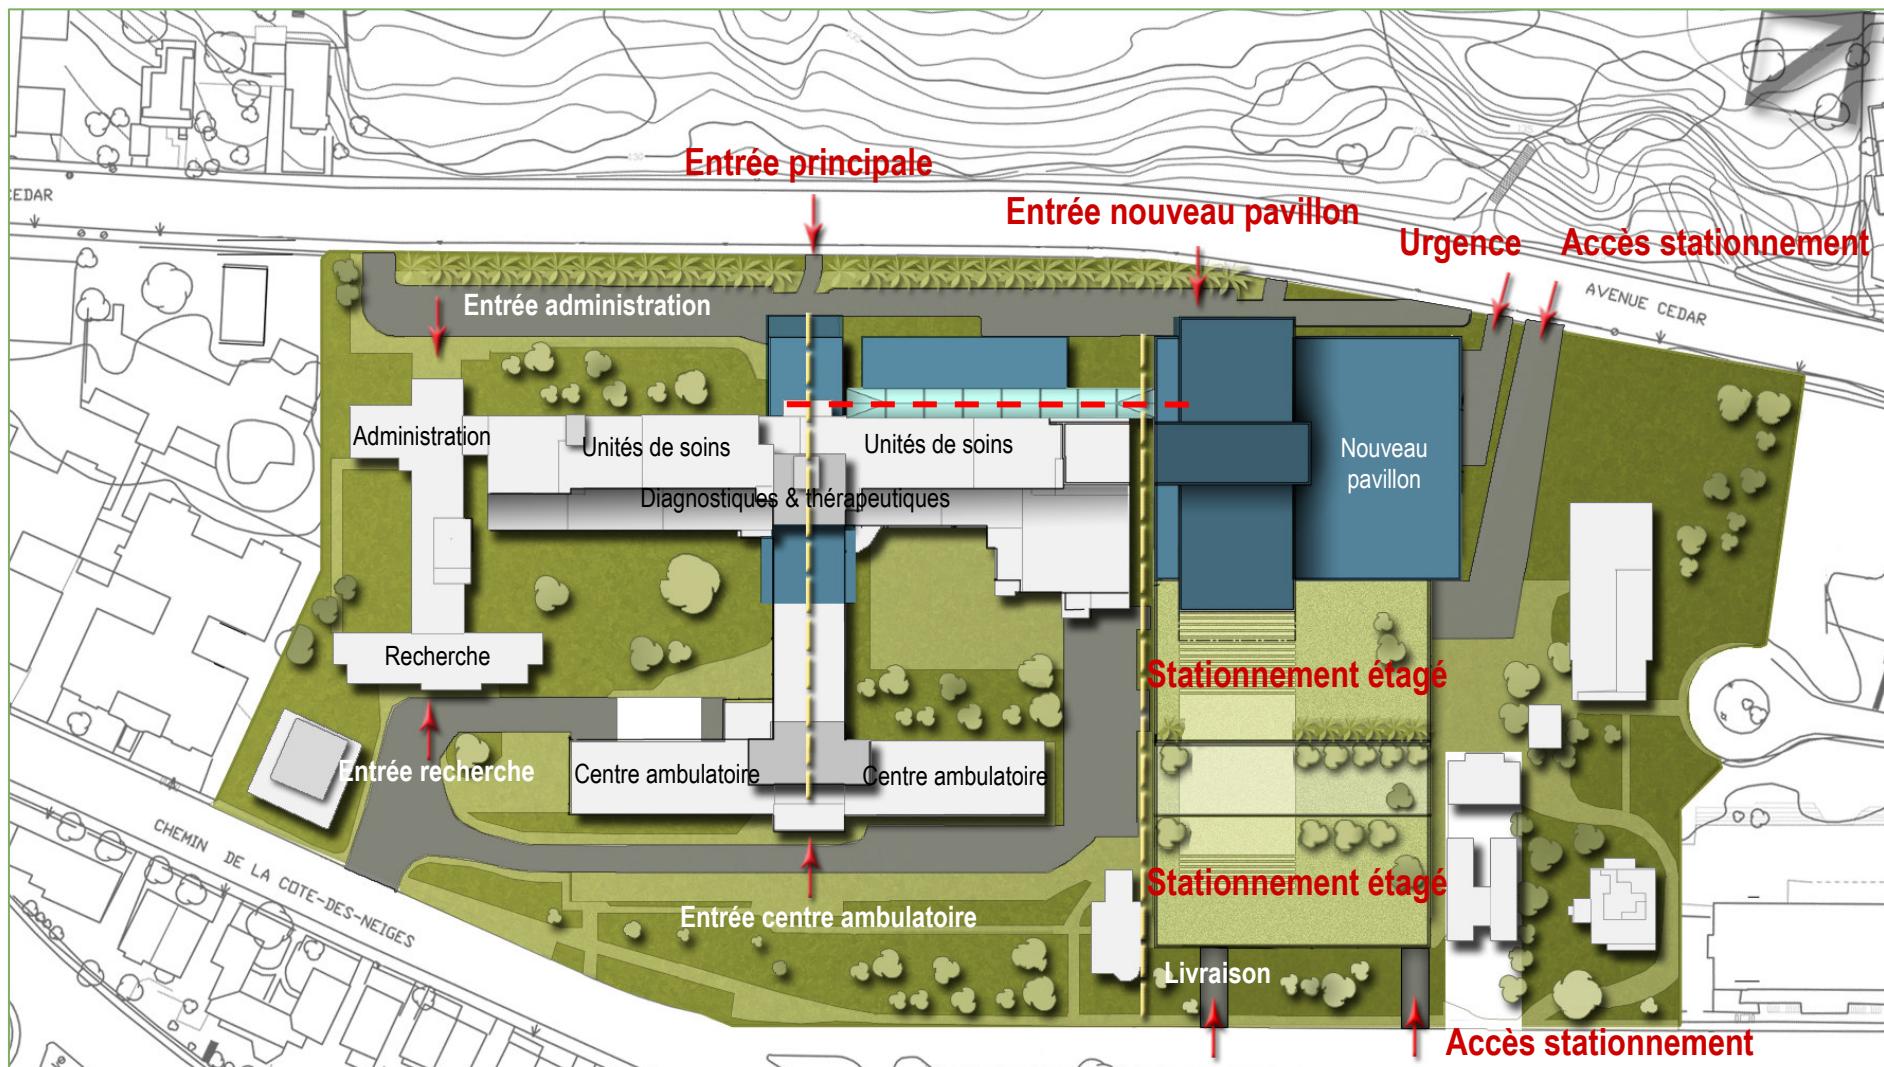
Plan d'implantation du projet de redéploiement du CUSM sur le site de la Montagne
